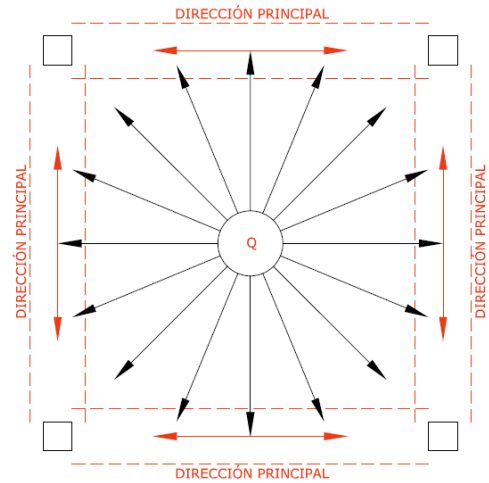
Esquema del comportamiento multidireccional de la losa maciza.
